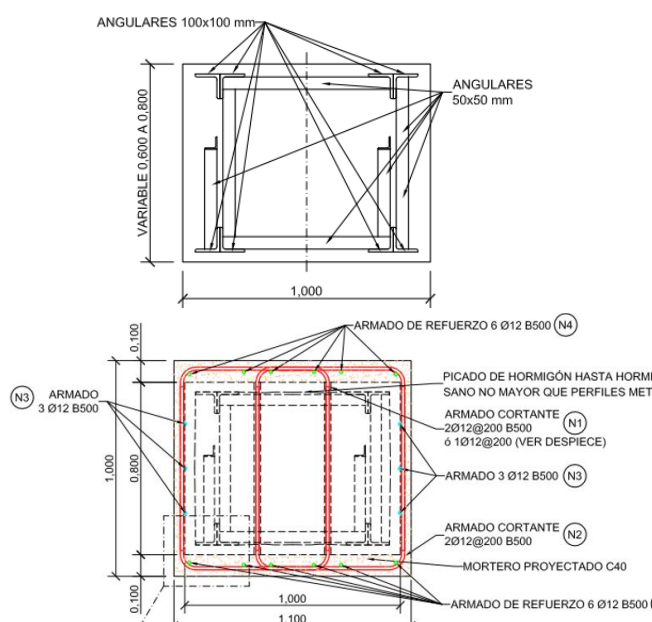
Sección inicial arco (izquierda) y sección con refuerzo empleado en zona de arranque arco (derecha)
